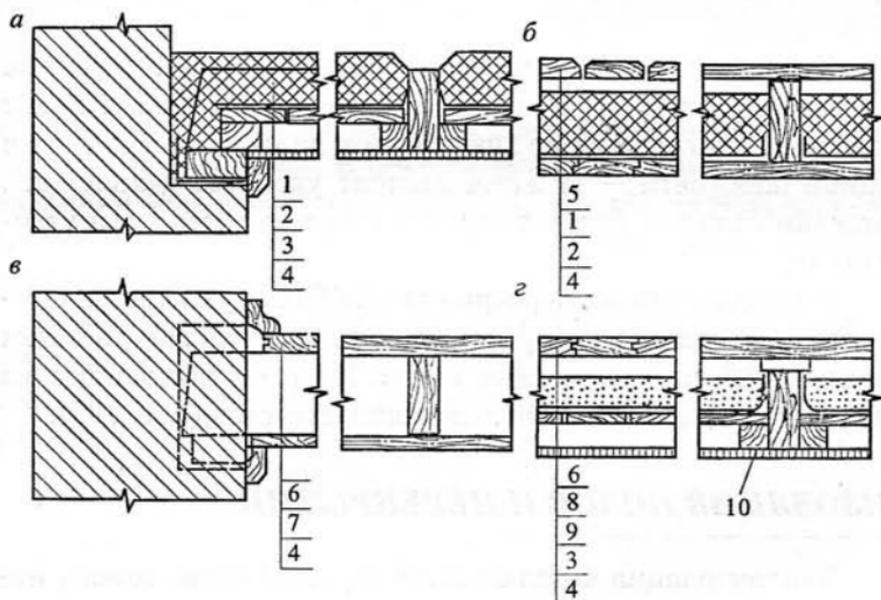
Фрагменты конструкции перекрытия по деревянным балкам:
